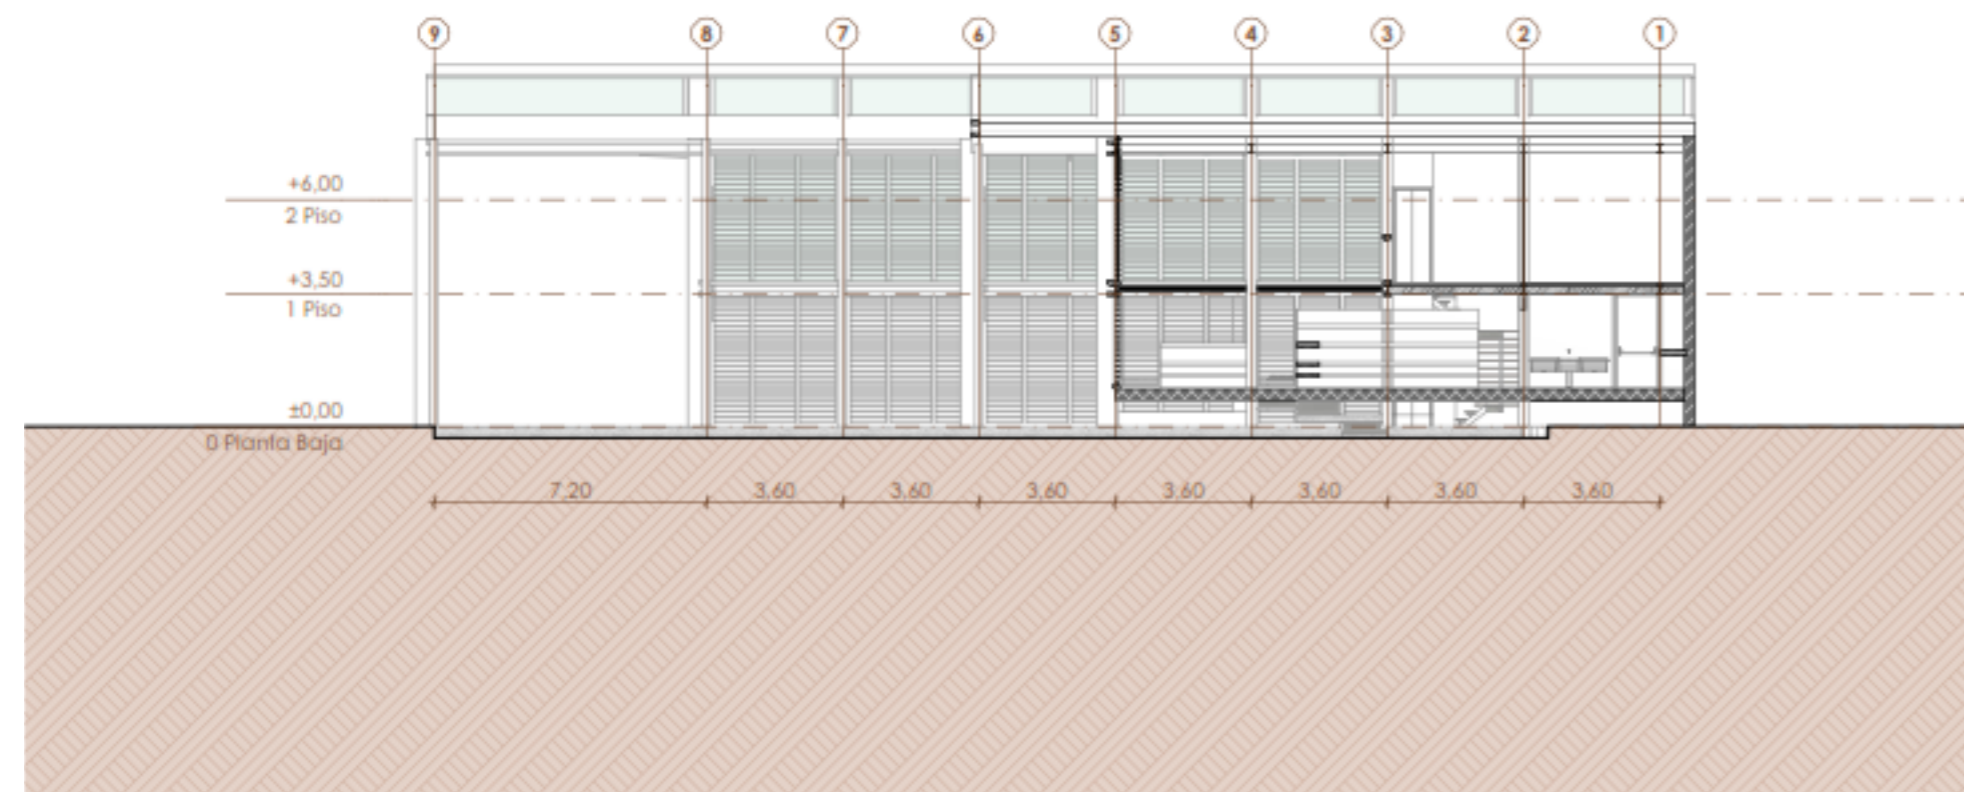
Sección izquierda Mercado Sacay. Fuente: Autoría propia (2026).
